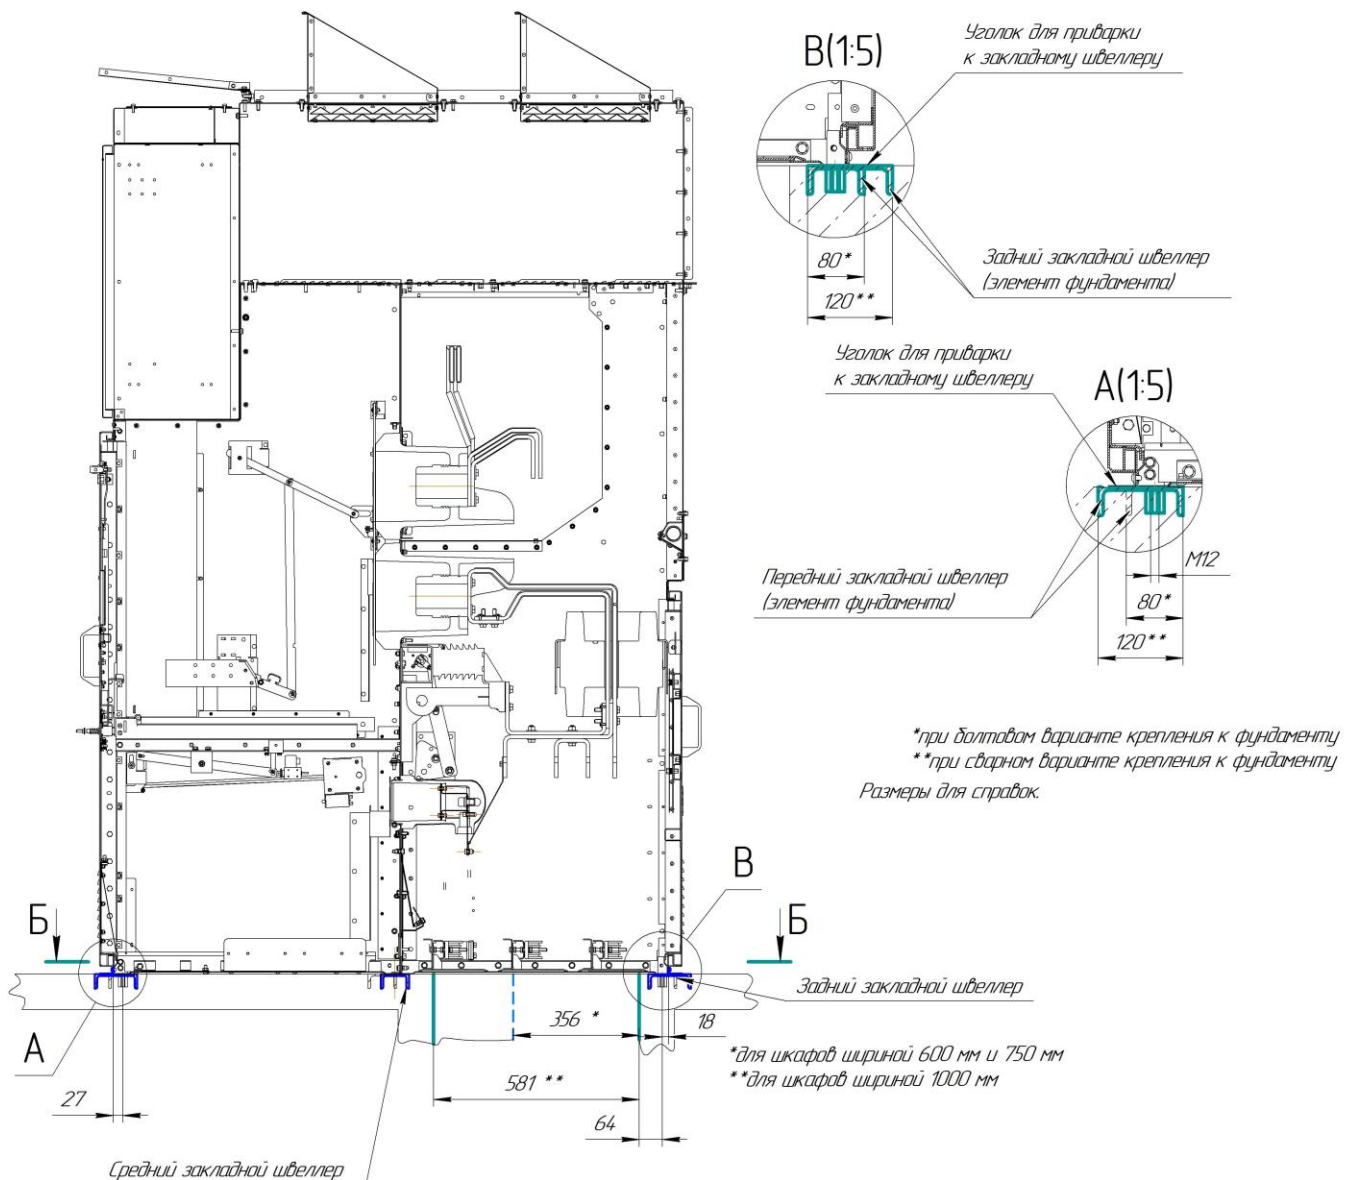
Установка СЭЩ-80-10Н на фундамент с кабельным каналом
